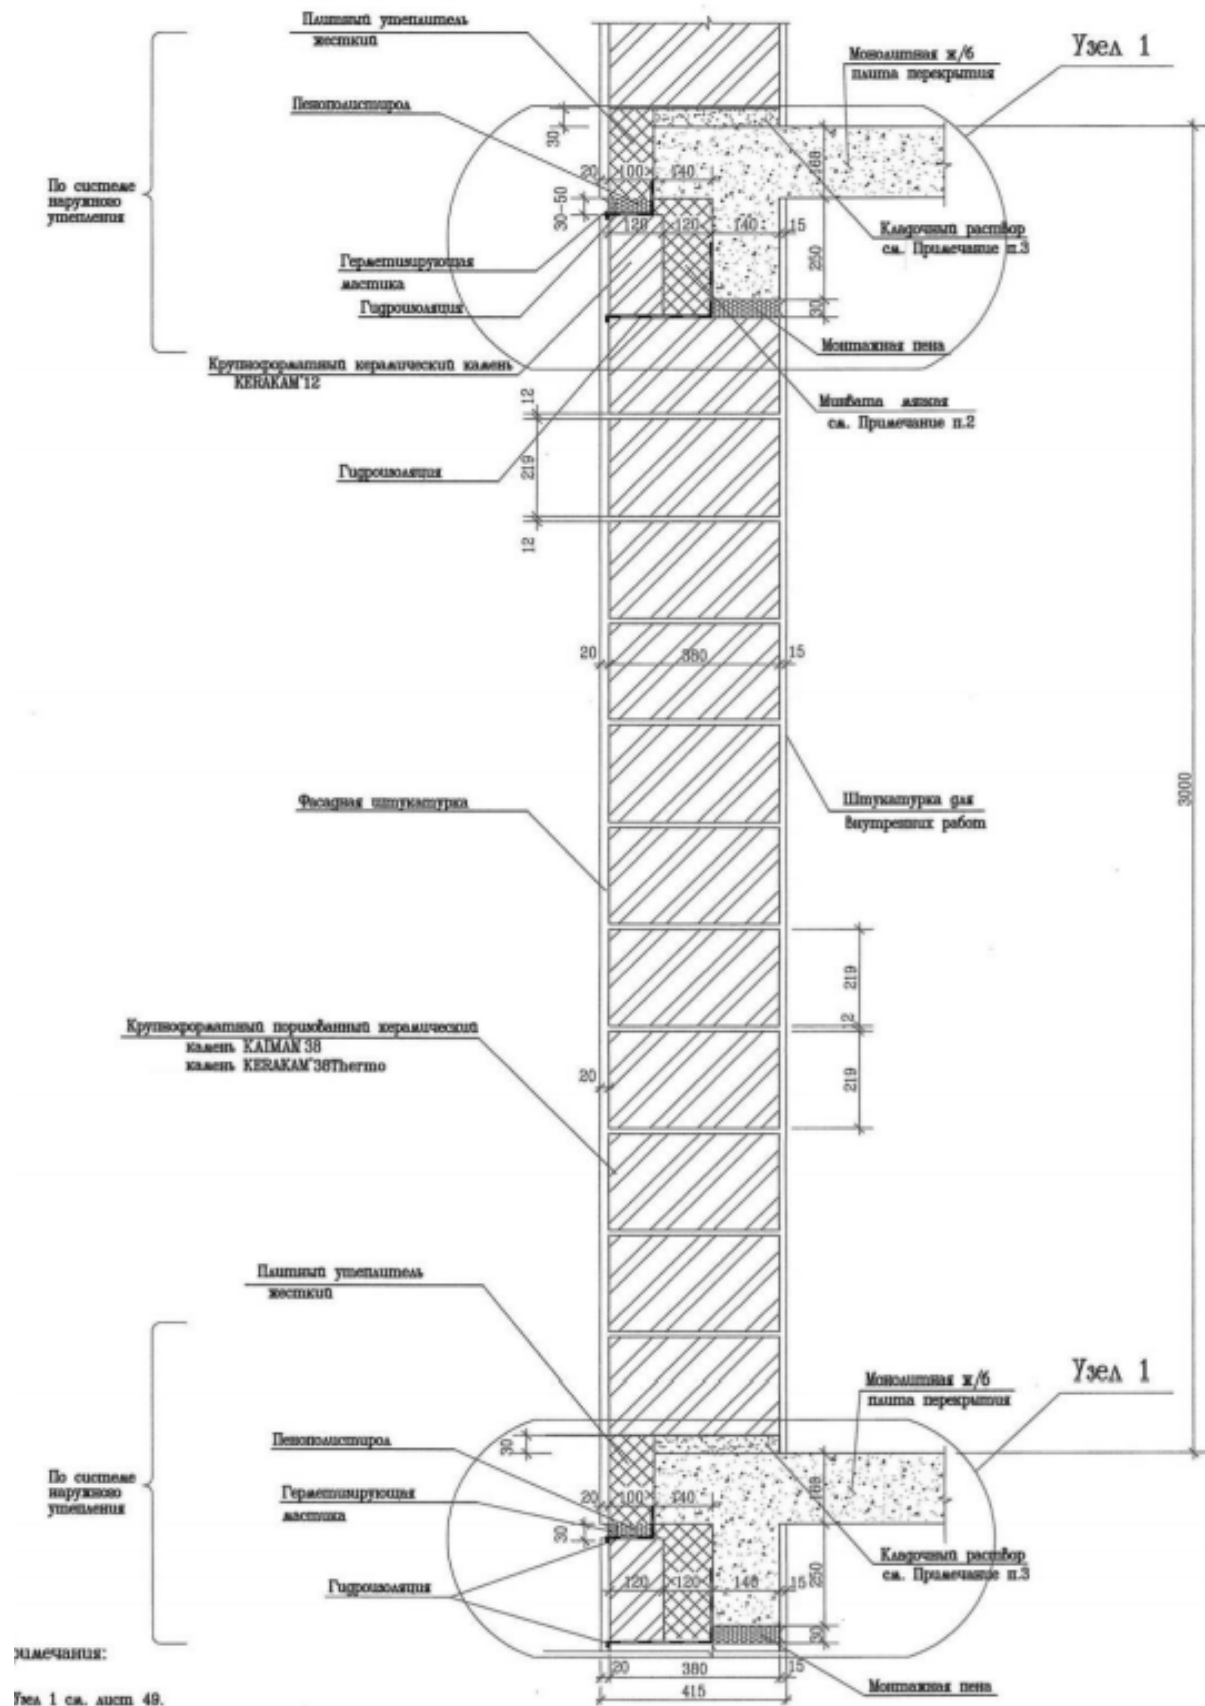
Разрез стены с плитой перекрытия с балкой без проемов.
